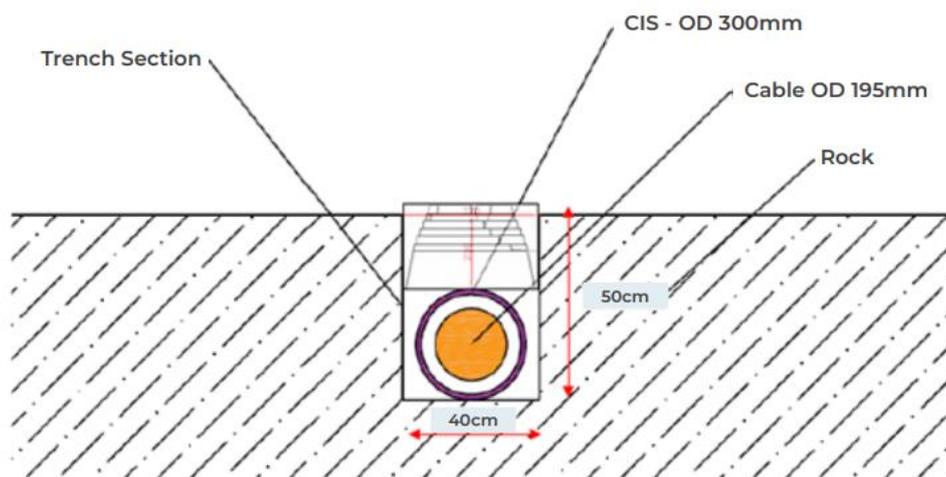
Sección transversal del sistema EConcrete para protección ecológica de cables submarinos. (red eléctrica & ECONCRETE, 2023)
